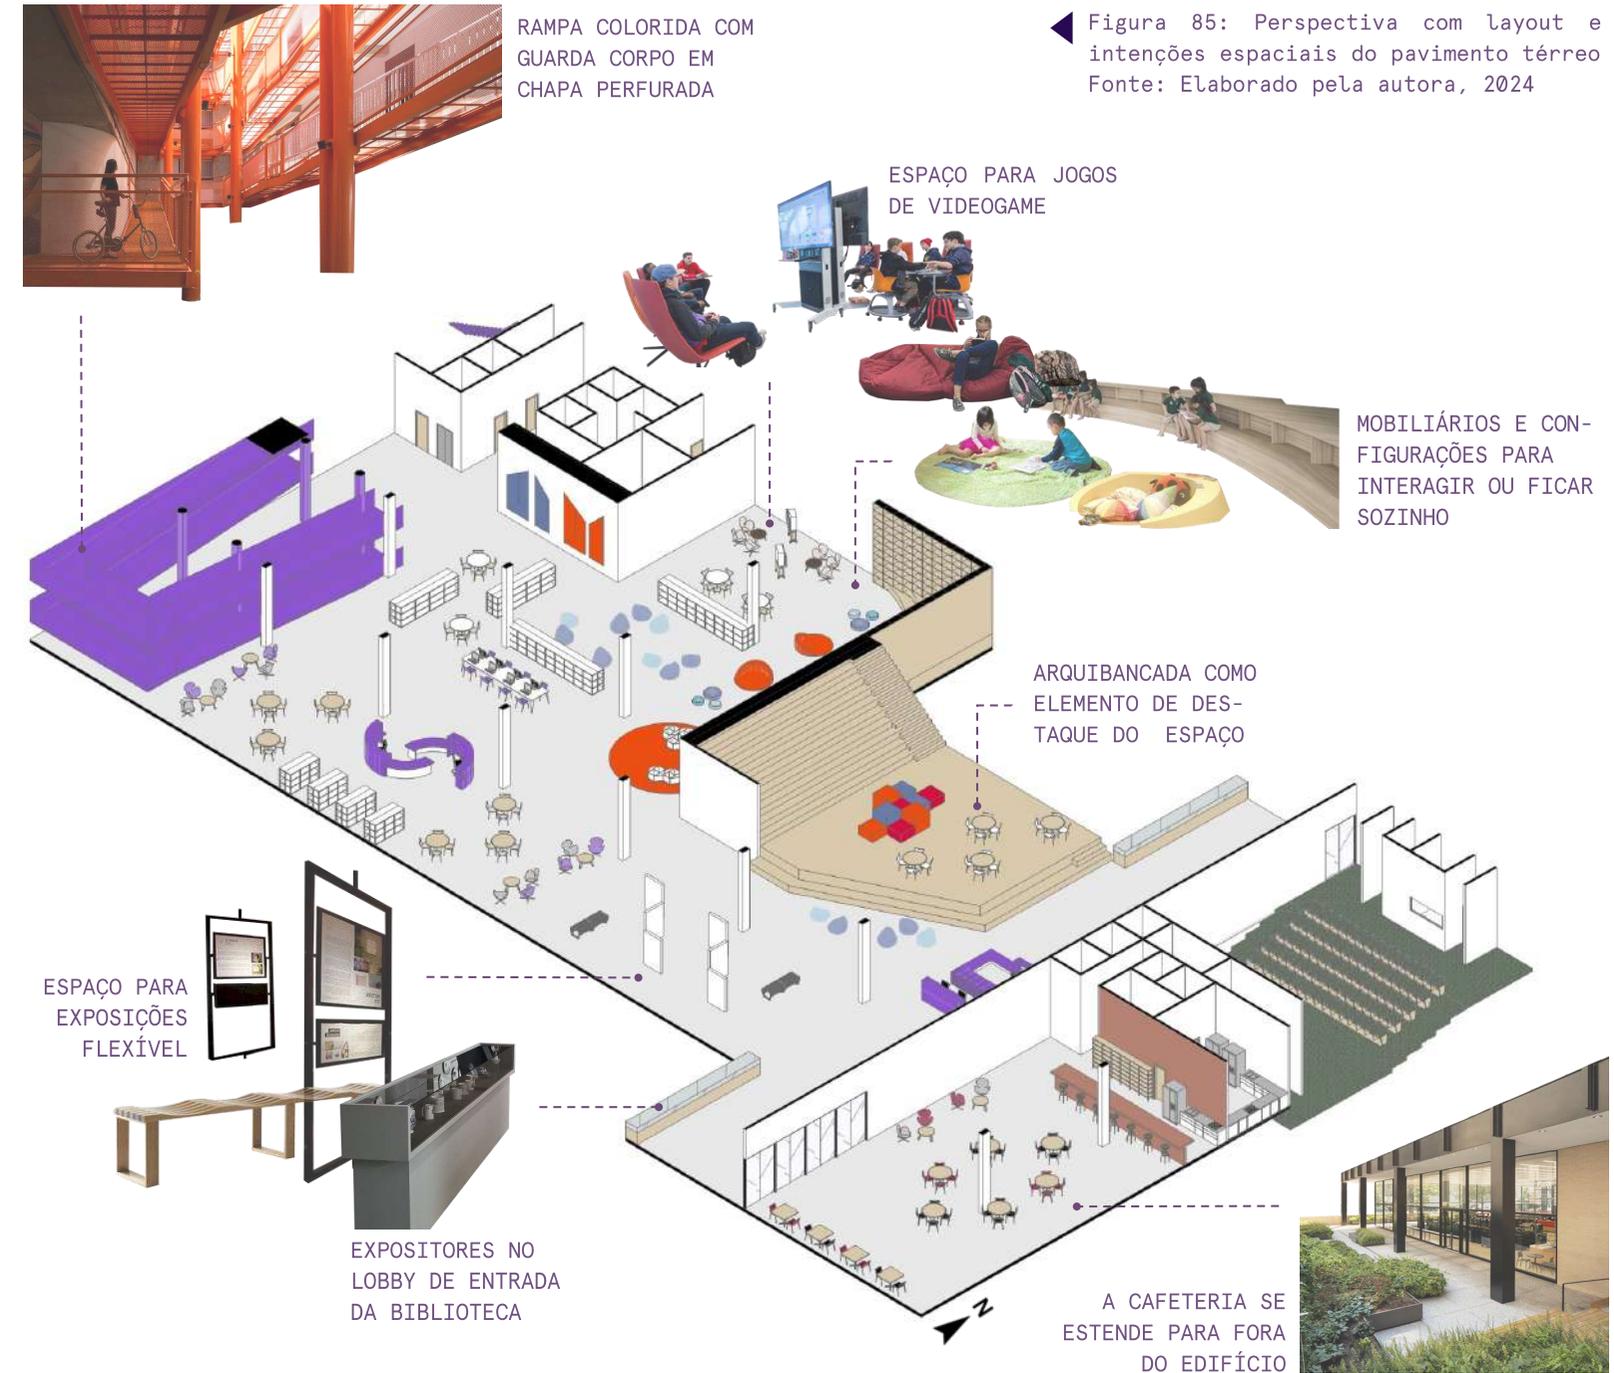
Perspectiva com layout e intenções espaciais do pavimento térreo
